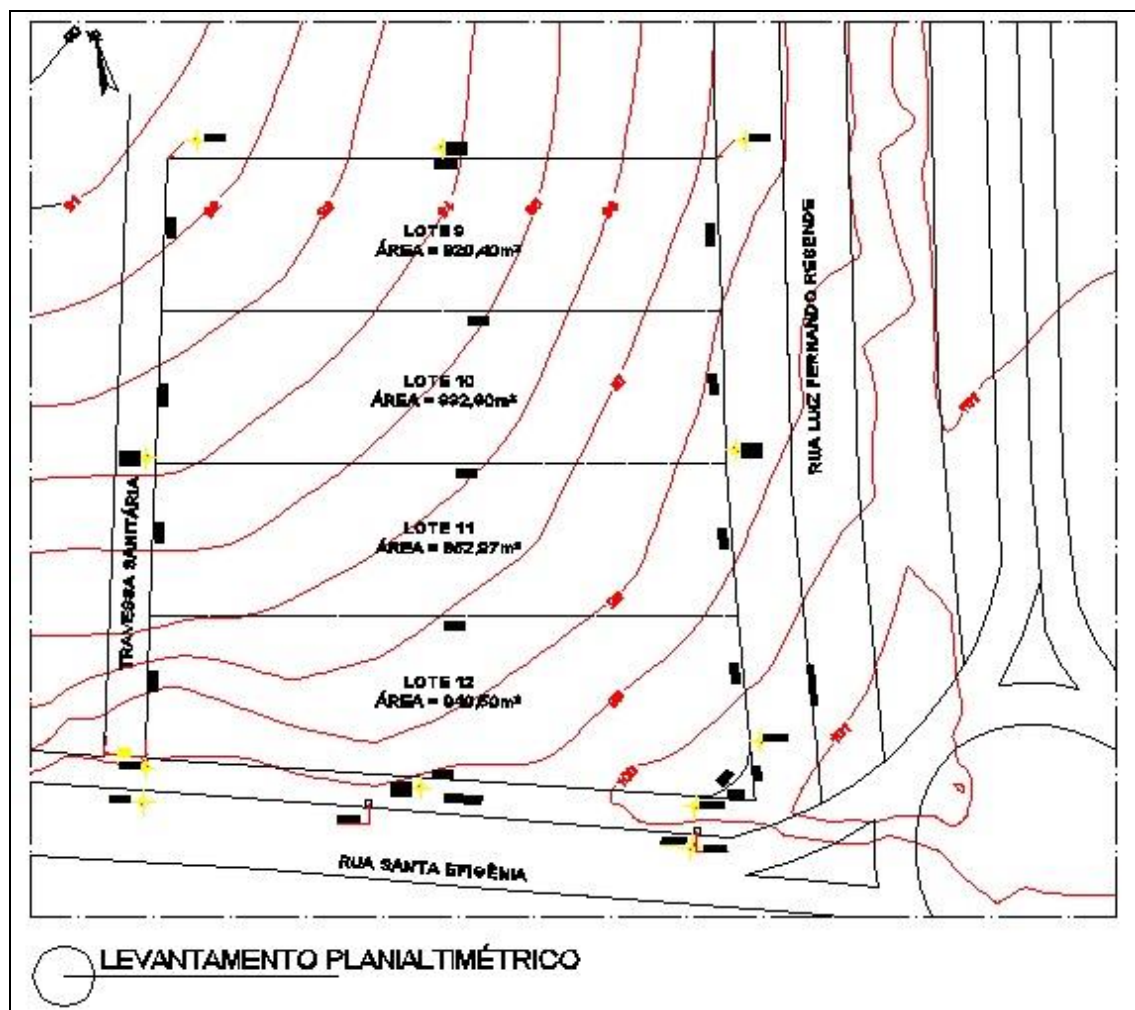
Levantamento Planialtimétrico da área – implantação da obra
